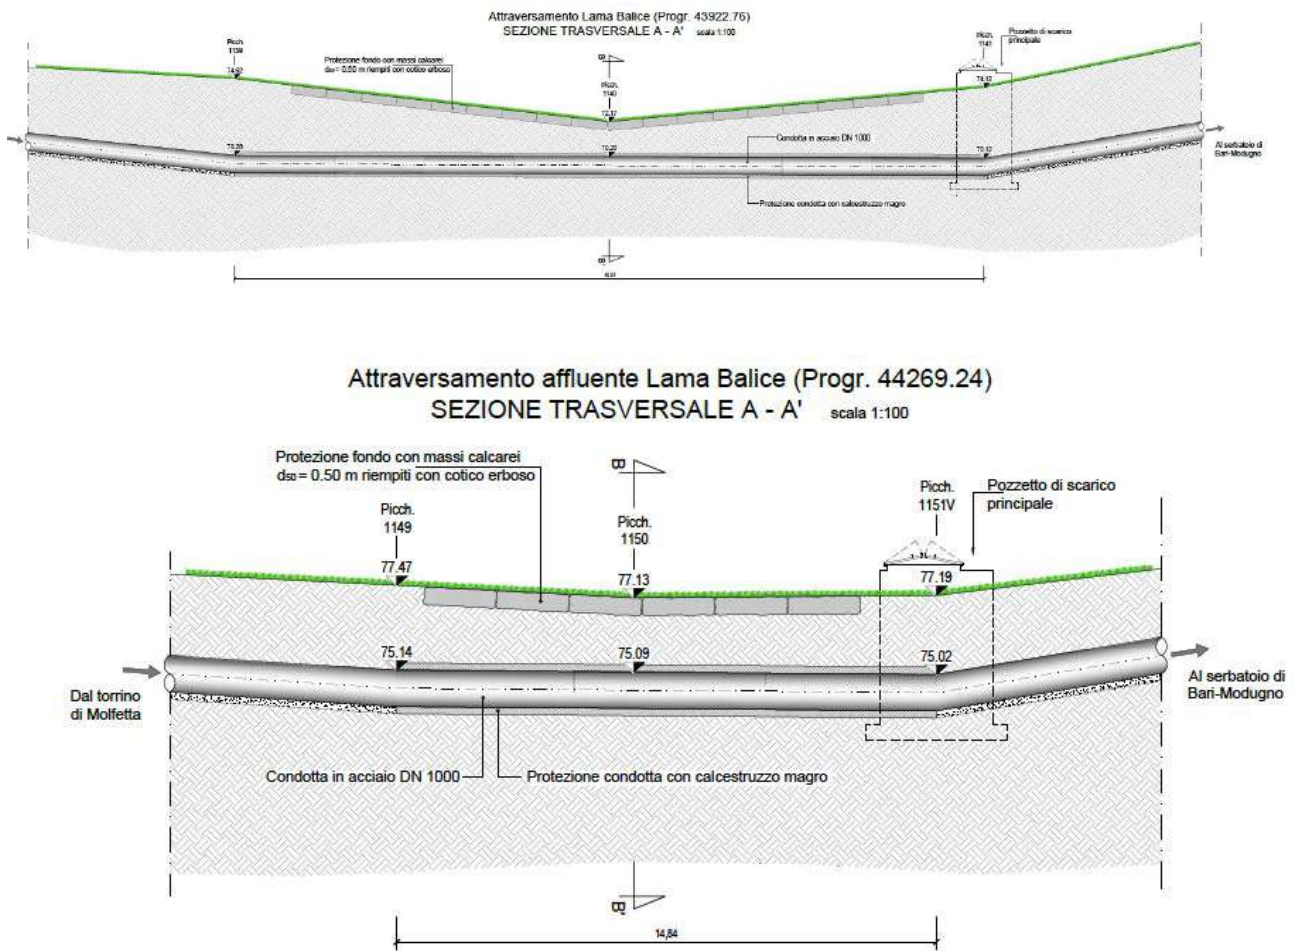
Sezione tipo Attraversamento lama ed affluente
